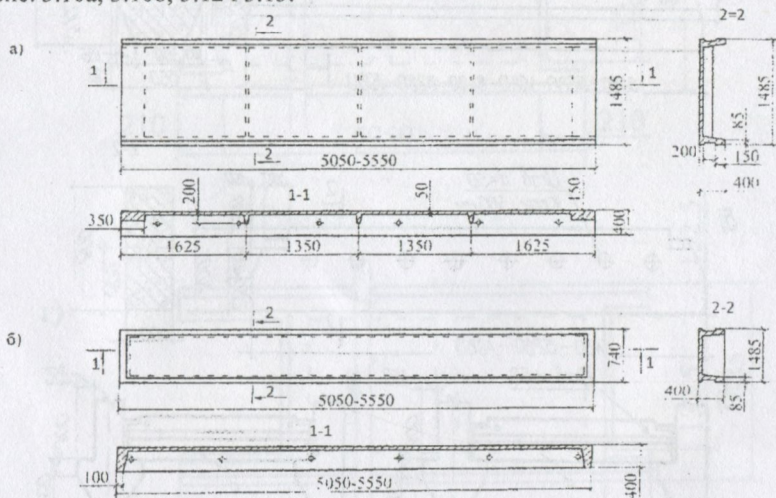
Залізобетонні ребристі плити перекриття для прямокутних ригелів: а – рядова плита; б – добірна плита
